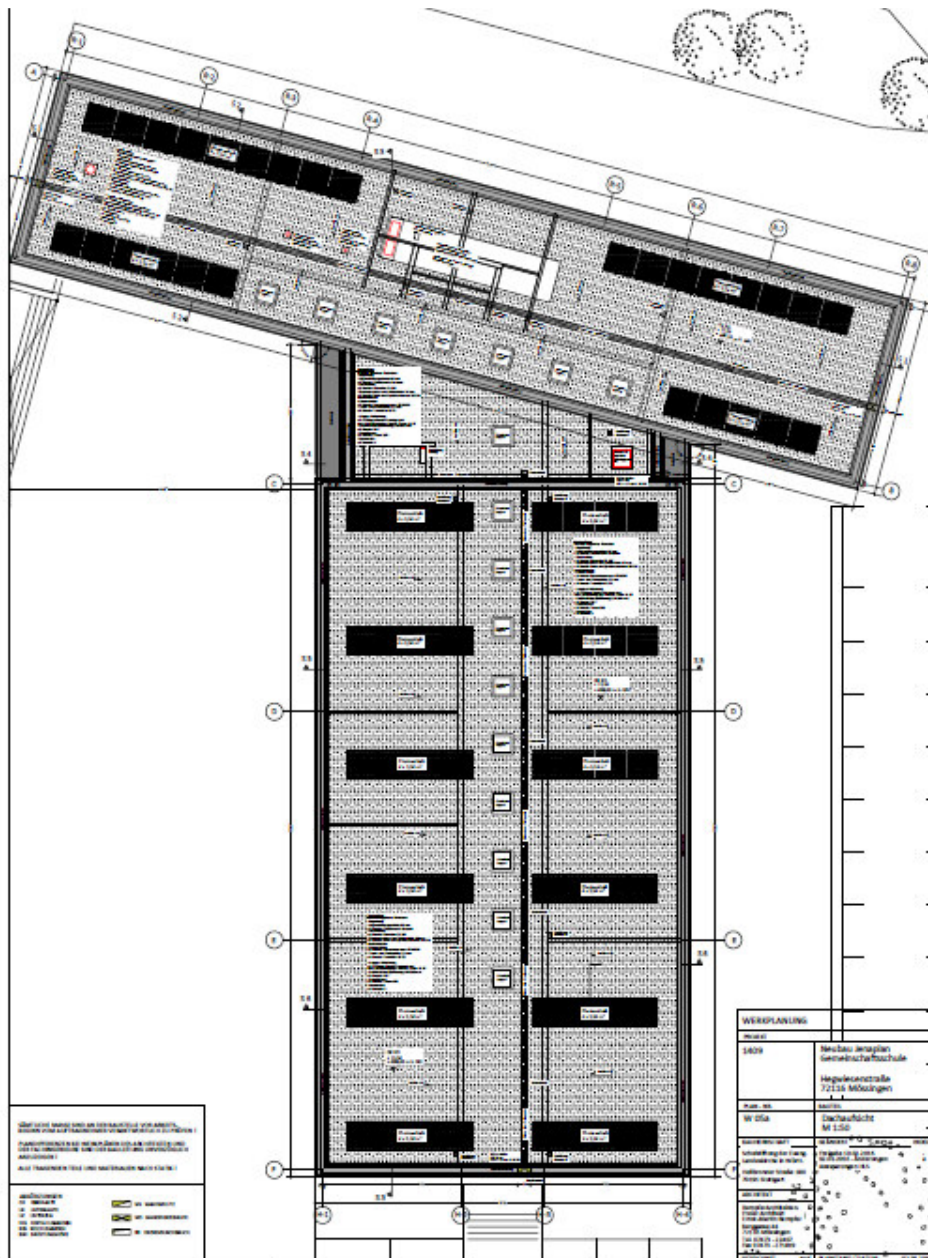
Werkplan – Dachaufsicht Jenaplan-Schule
